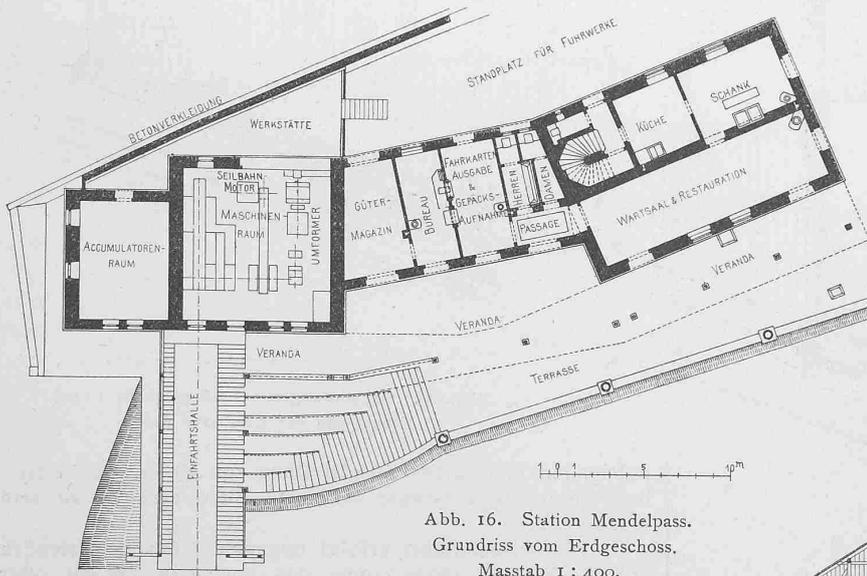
Station Mendelpass. Grundriss vom Erdgeschoss. Masstab 1 : 400.
